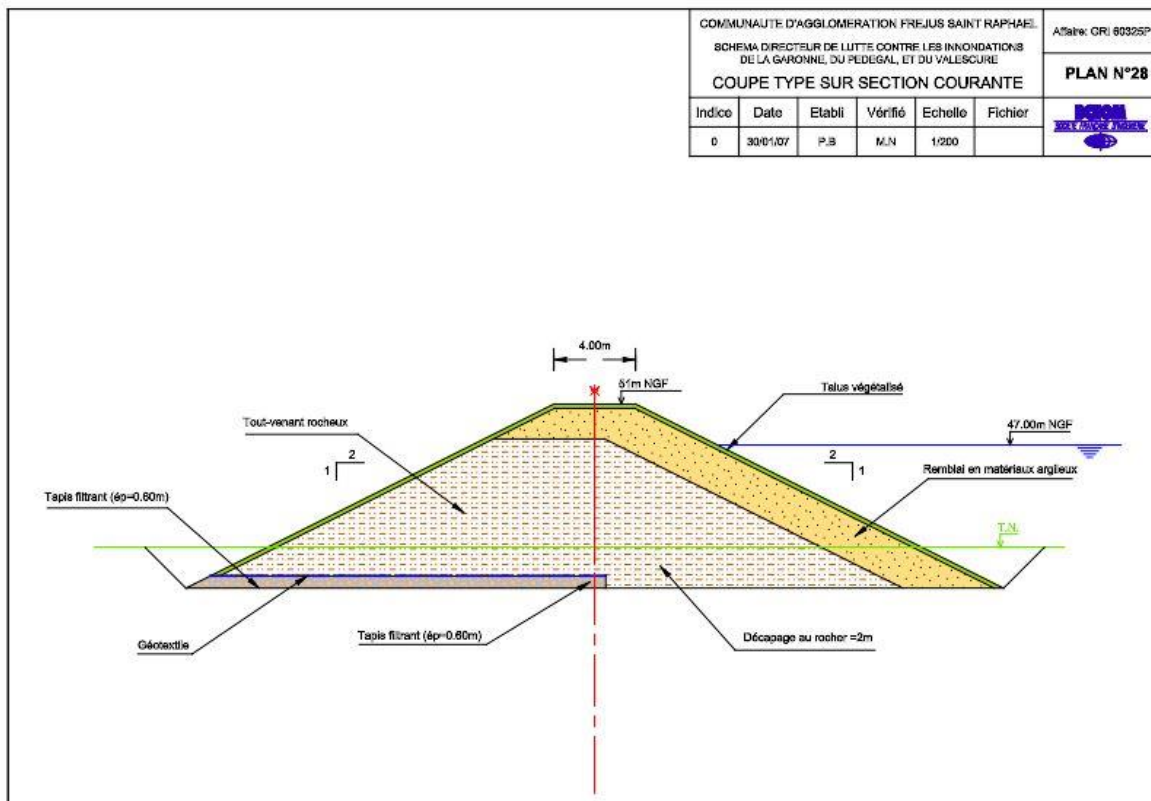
Plan en coupe au niveau de la section courante (Source : CAVEM)
